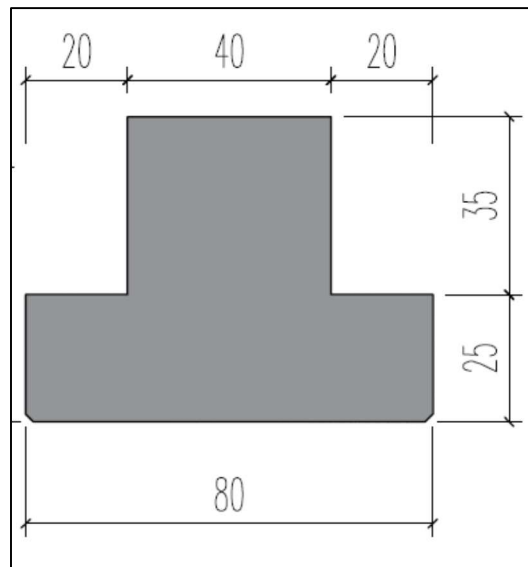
Sezione trasversale trave prefabbricata - sezione in campata
